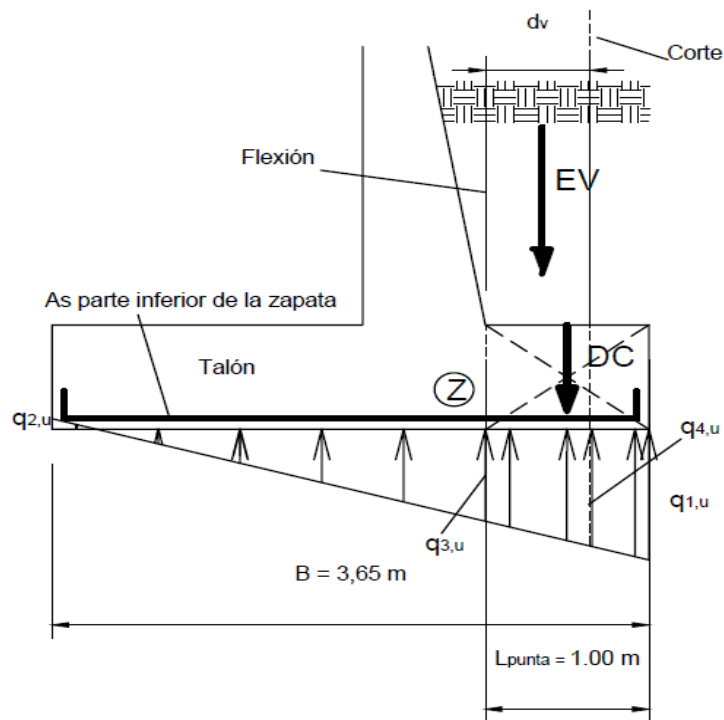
Acero de Refuerzo en parte inferior de la Zapata
